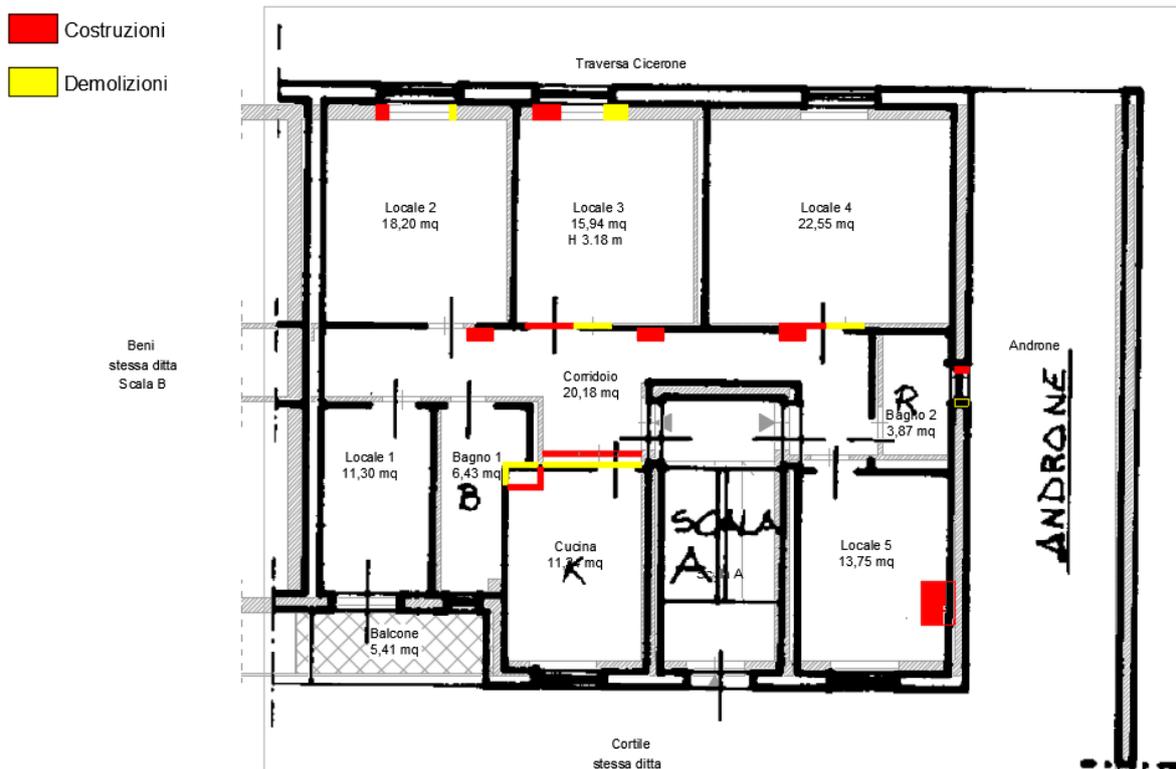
Confronto con planimetria catastale (Foglio 4, p.lla 1225, sub. 2)
